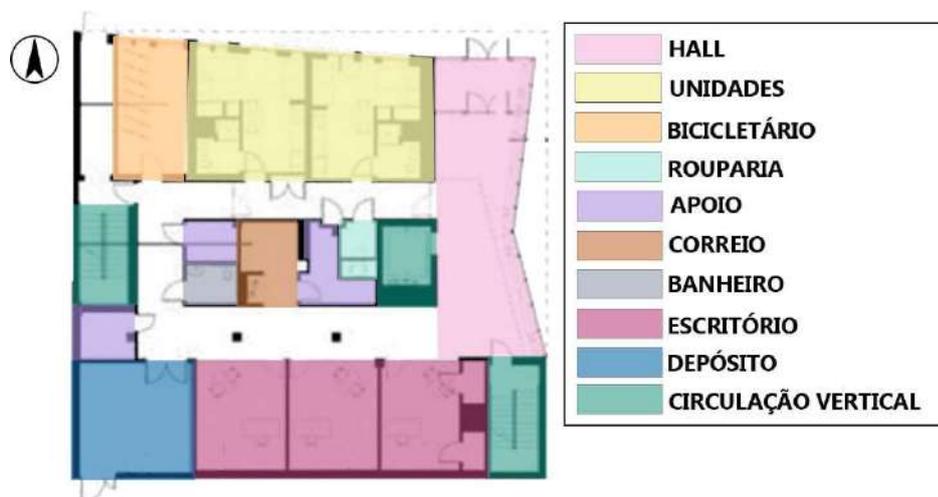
Setorização planta primeiro pavimento. Fonte: Archdaily. Adaptado pela autora. Sem escala.
